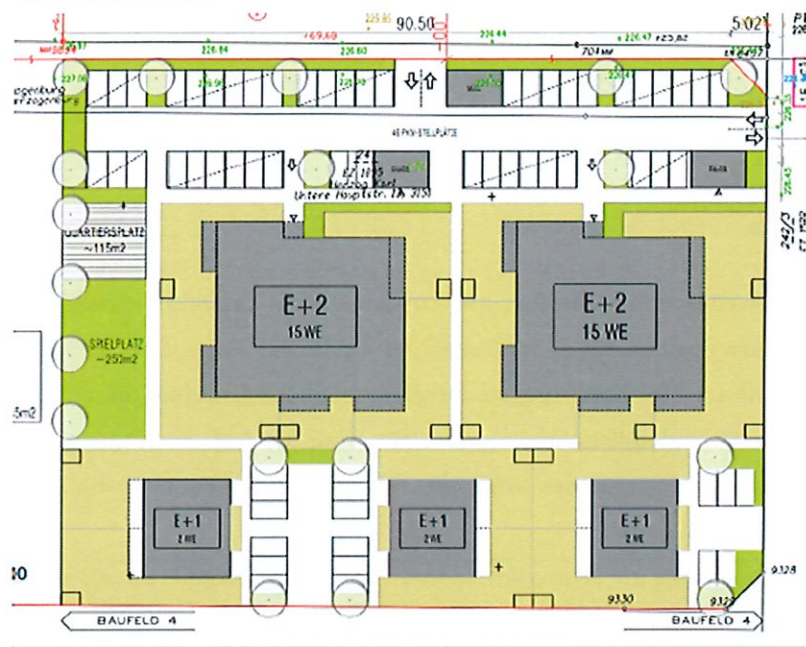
Lageplan zum Projektvorhaben von Architekt Christian Galli
